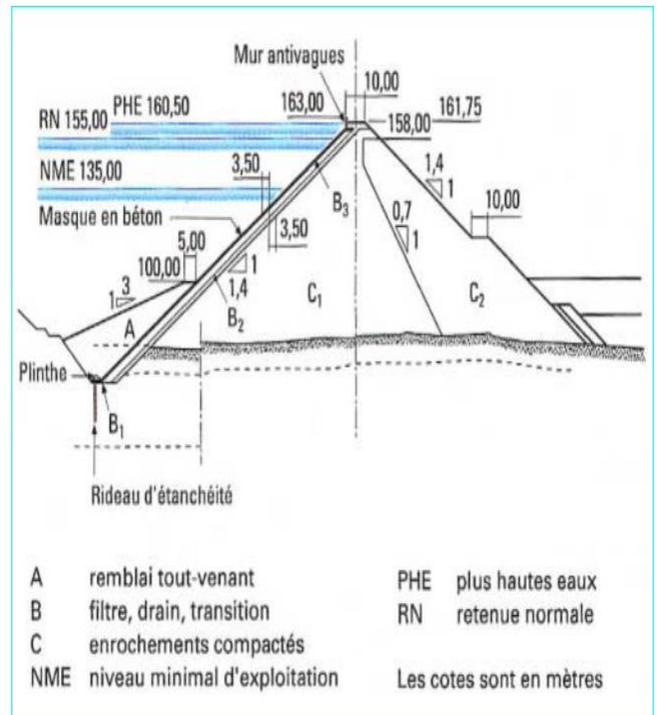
Barrage à masque en béton de Khao Laem (Thaïlande)
